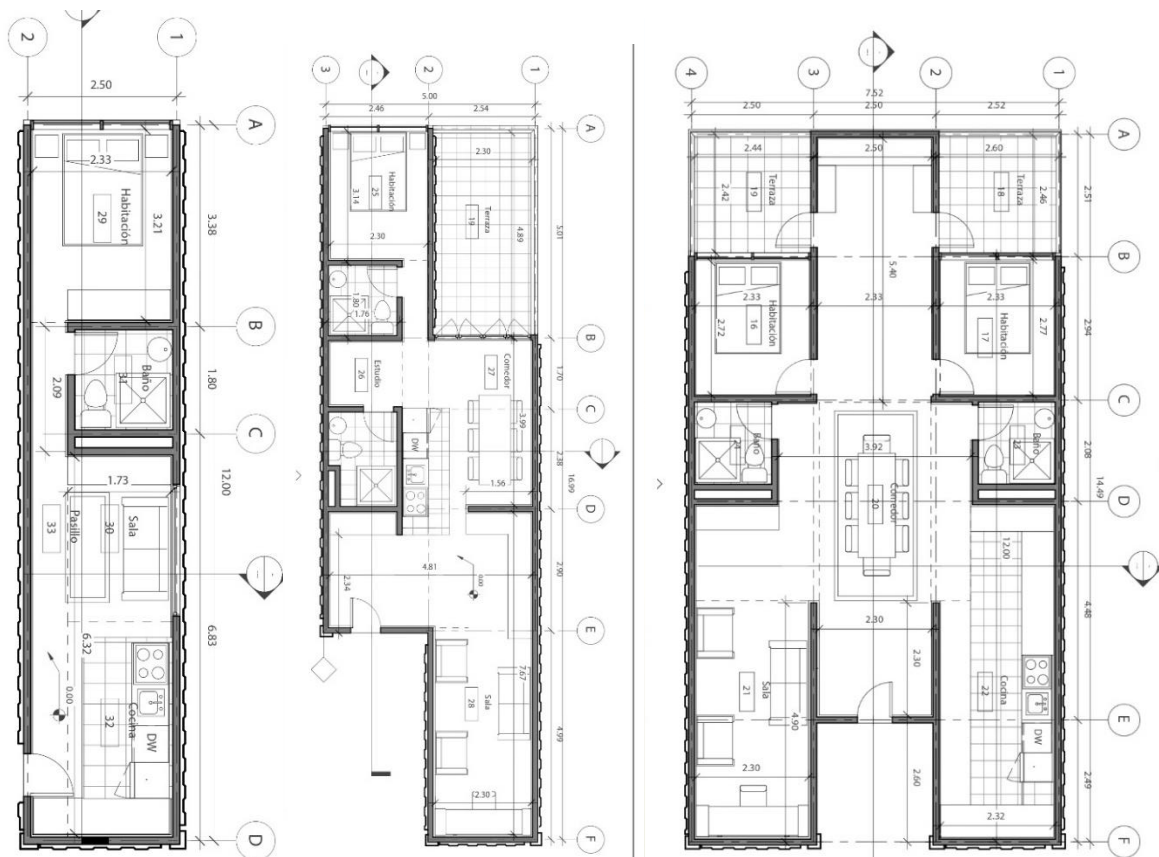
Plantas técnicas de las tipologías del proyecto torres Jaquez – Fuente propia.
